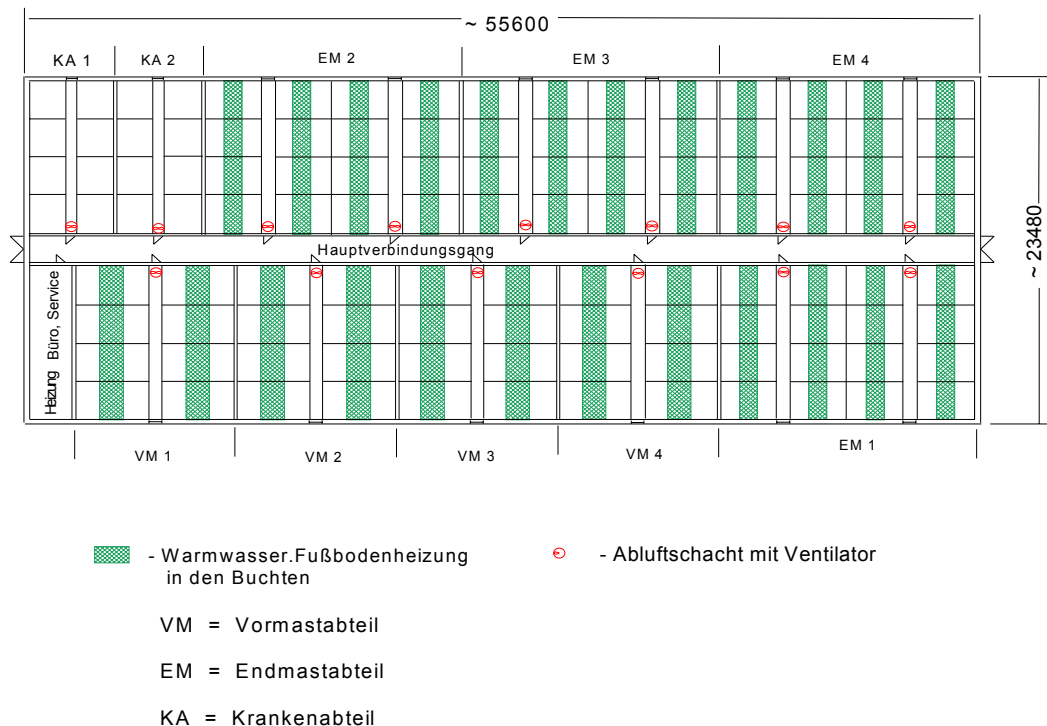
Charakteristischer vereinfachter Grundriss des Schweinestalles mit Unterflur-Zuluftführung [27]
